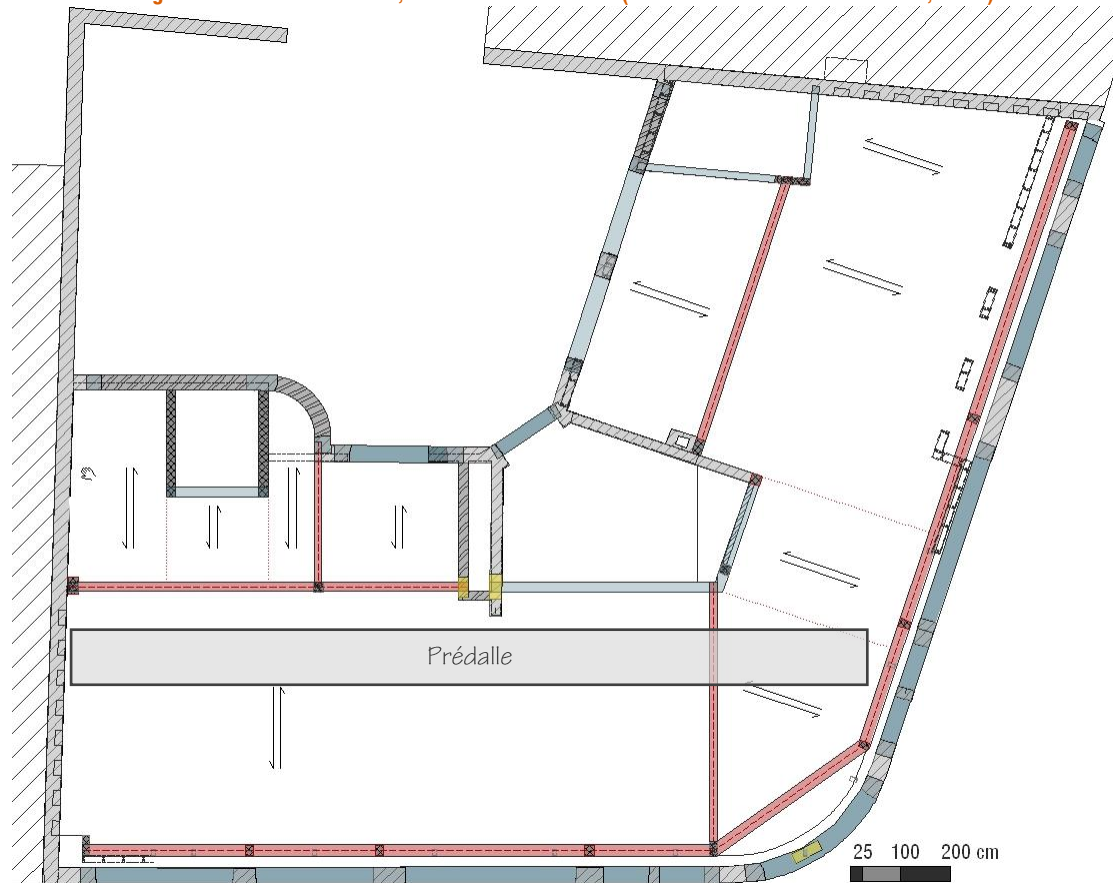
Plan de stabilité, haut 1<sup>er</sup> étage (Source: Bureau JZH & Partners, 2010)
